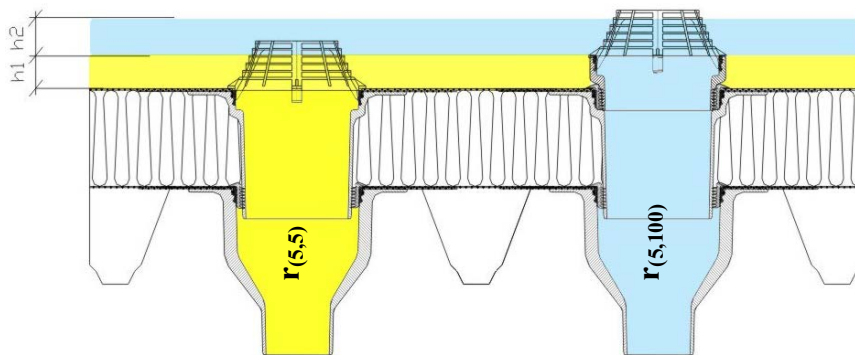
Prinzipschema Dach- und Notentwässerungssystem
